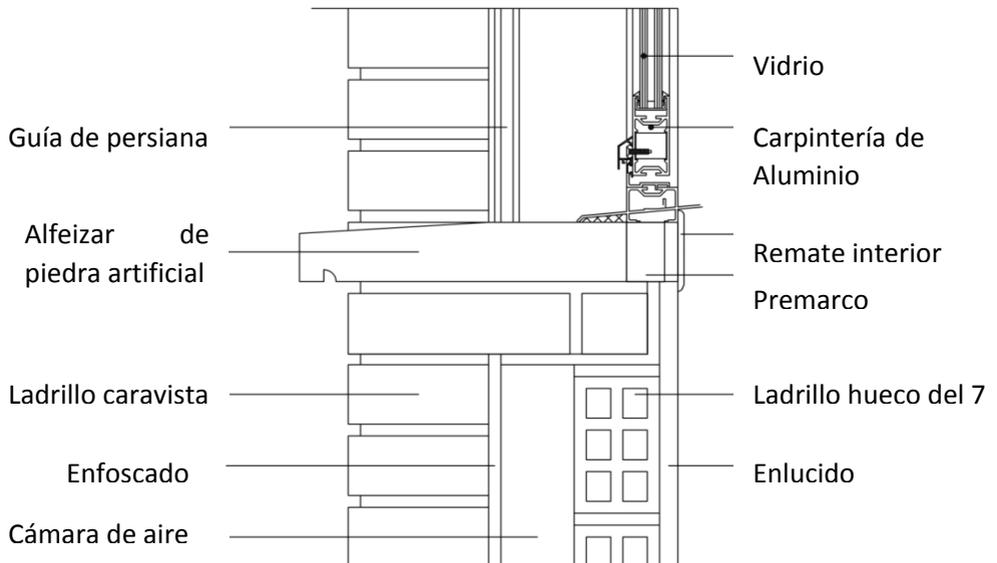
Detalle constructivo de vierteaguas. Fuente propia 2014.
